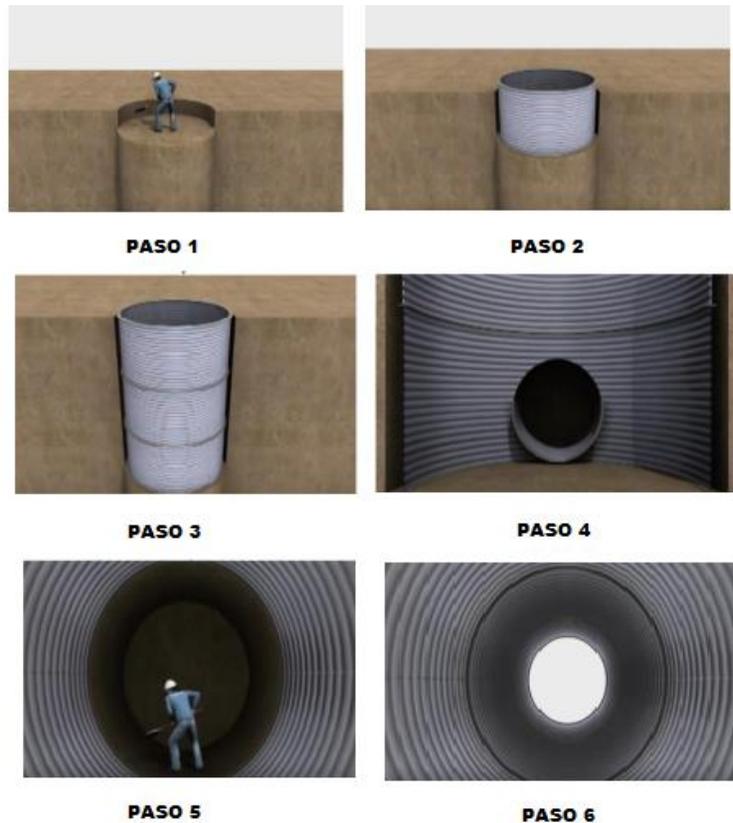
Procedimiento Constructivo Del Tunnel Liner
